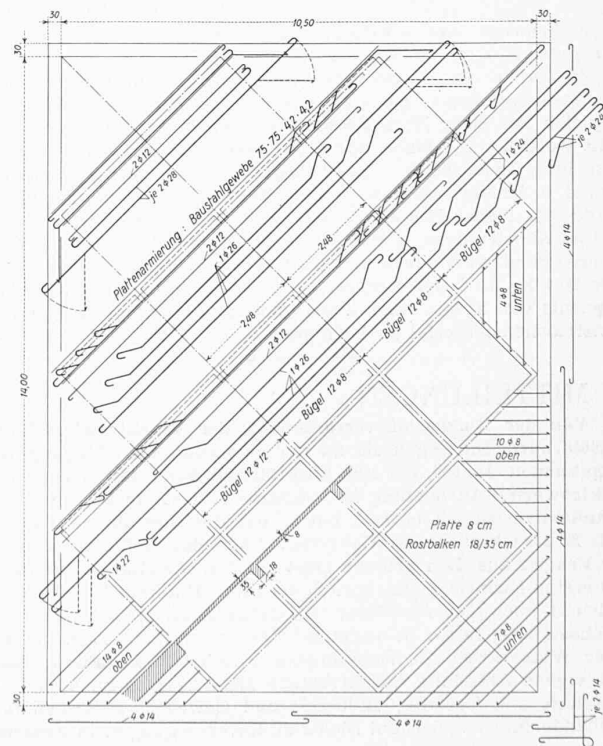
Ausführungsplan einer Eisenbeton-Diagonalrost-Decke von Ing. E. MAIER, Schaffhausen. — Masstab 1:150
